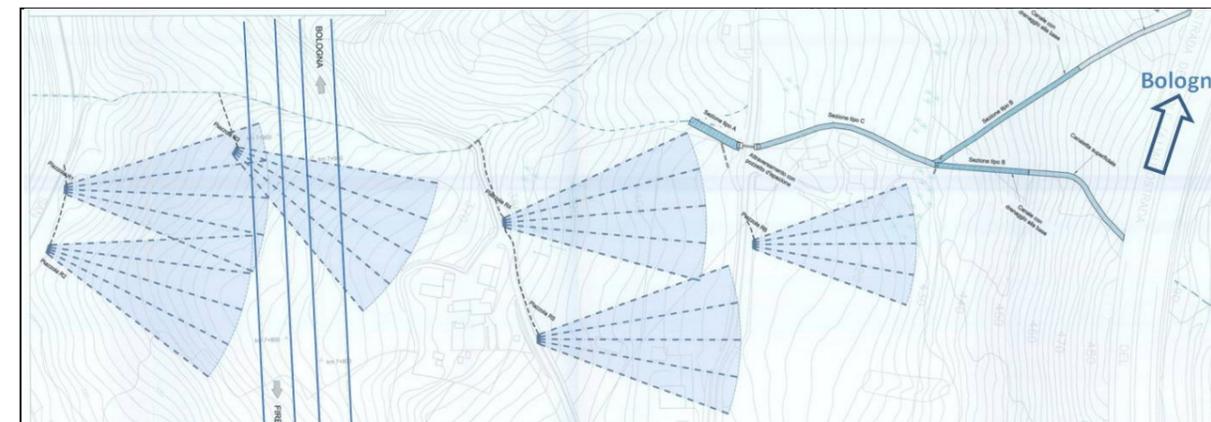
schema planimetrico degli interventi di drenaggio superficiale
